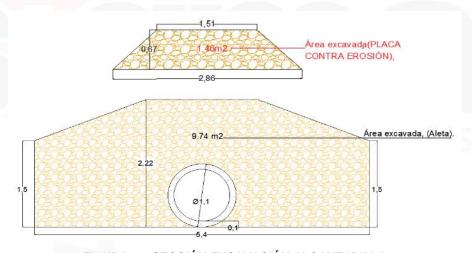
SECCIÓN EXCAVACIÓN ALCANTARILLA
